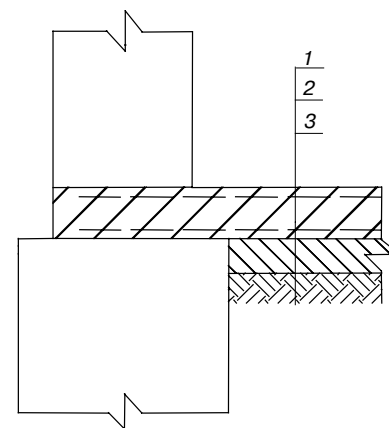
Сплошной барьер (плита пола): 1 – монолитный железобетон; 2 – подготовка из тощего бетона; 3 – уплотненный грунт
